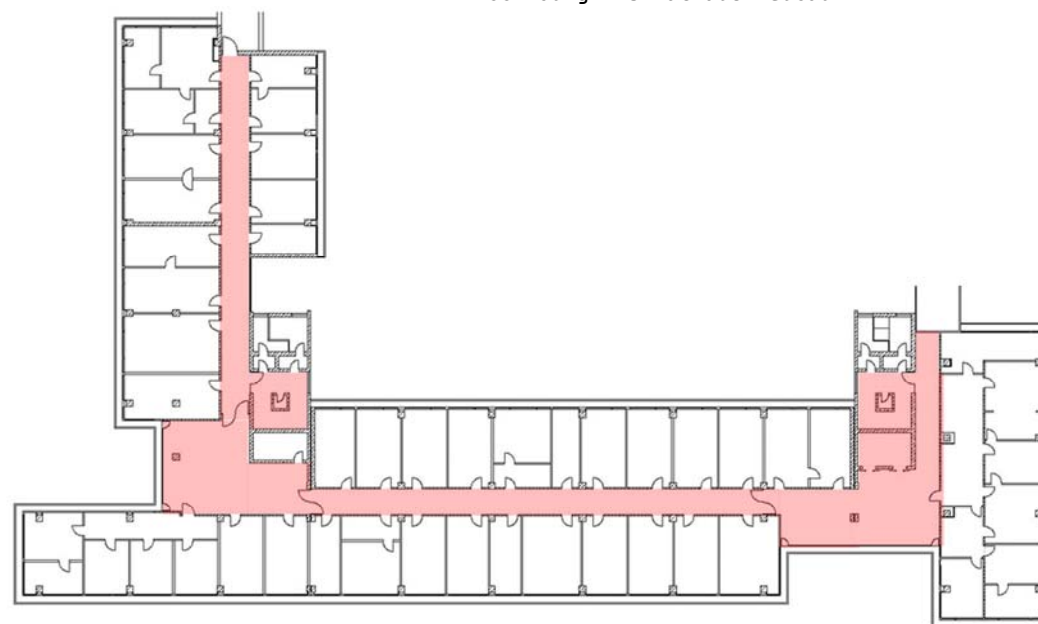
Grundriss Regelgeschoss 2.OG
